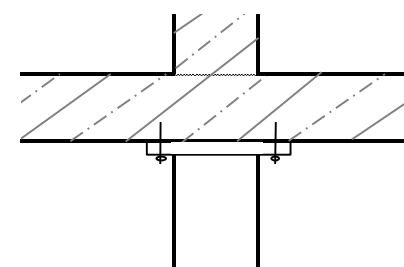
Knotenpunkt Stahlstütze-Betondecke
